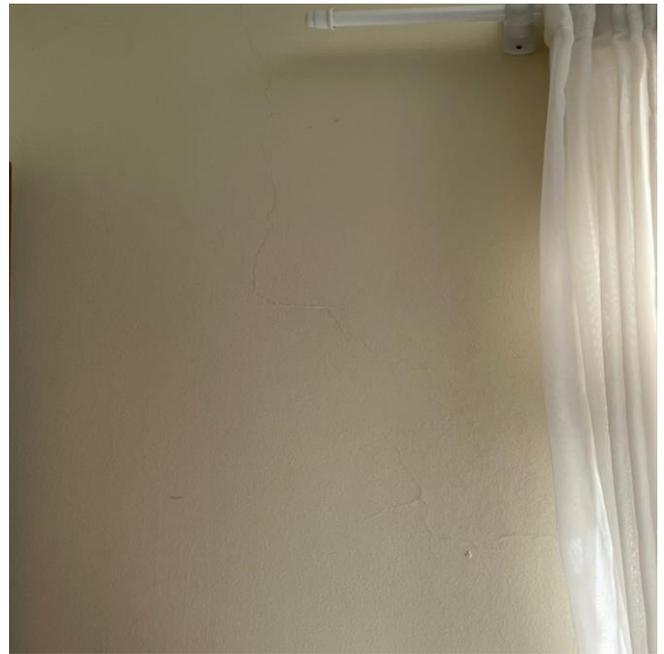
Apartamento 101 e do bloco A - Fissuras na parede.
